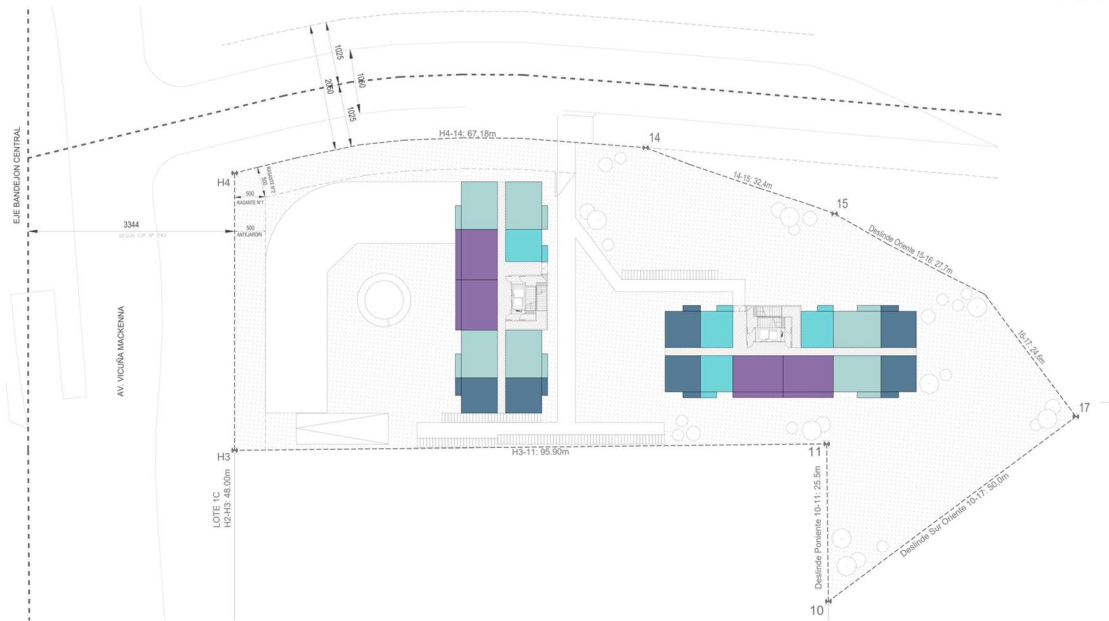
Planta piso 3 al 17. Fuente: Elaboración propia
